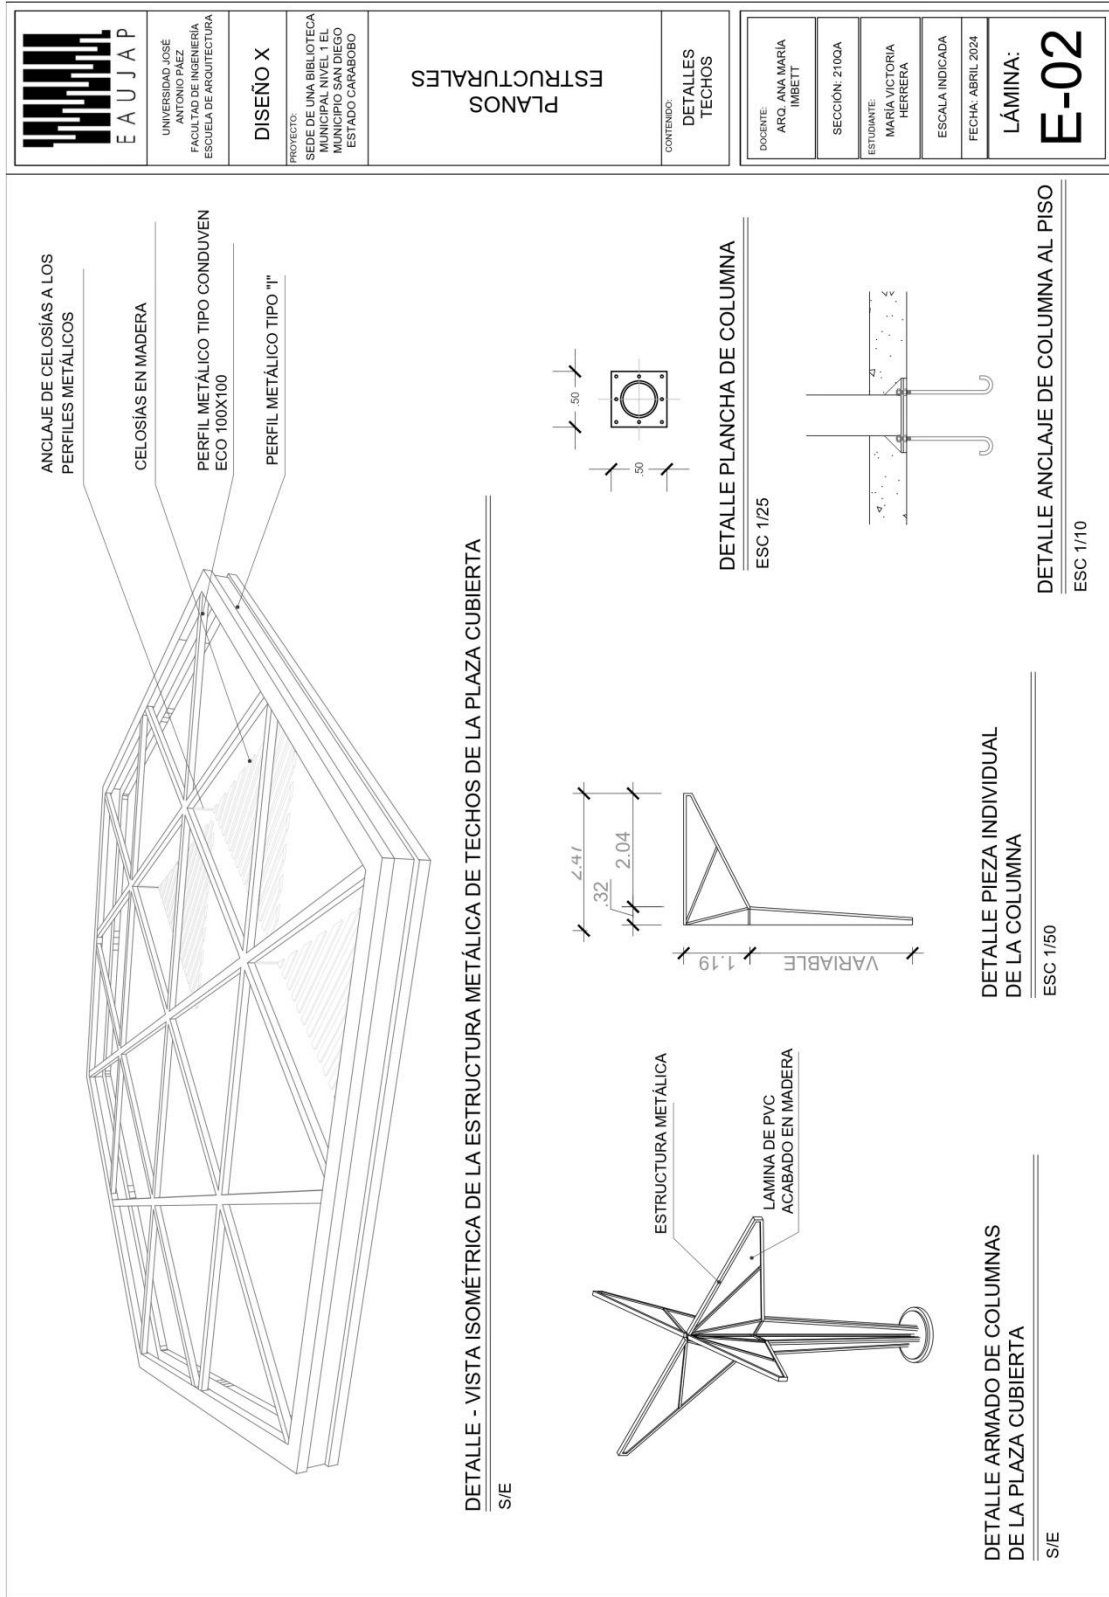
E-02 Detalles estructurales Fuente: La Autora (2024)
